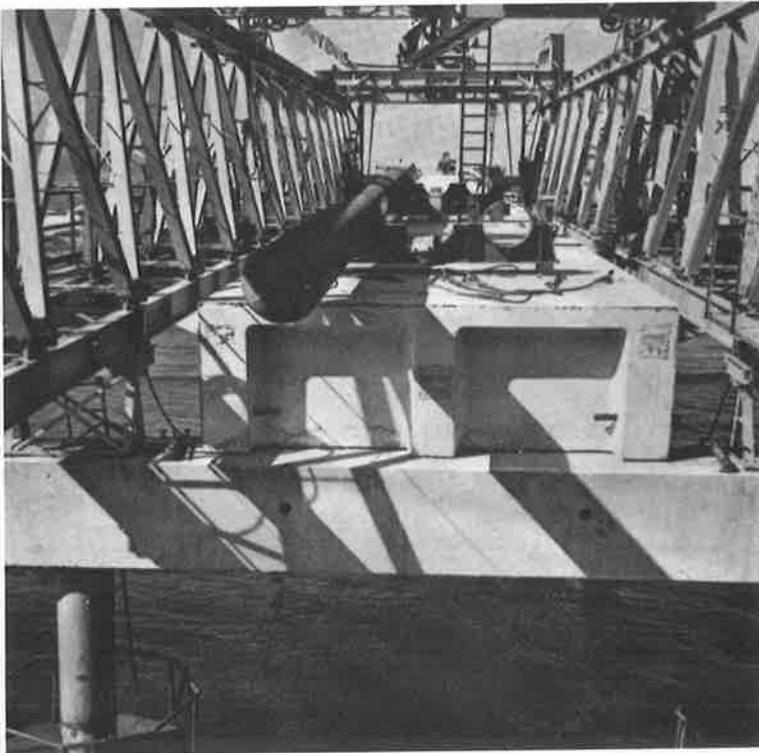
Pontile RUMIANCA - Varo longitudinale degli impalcato prefabbricati
